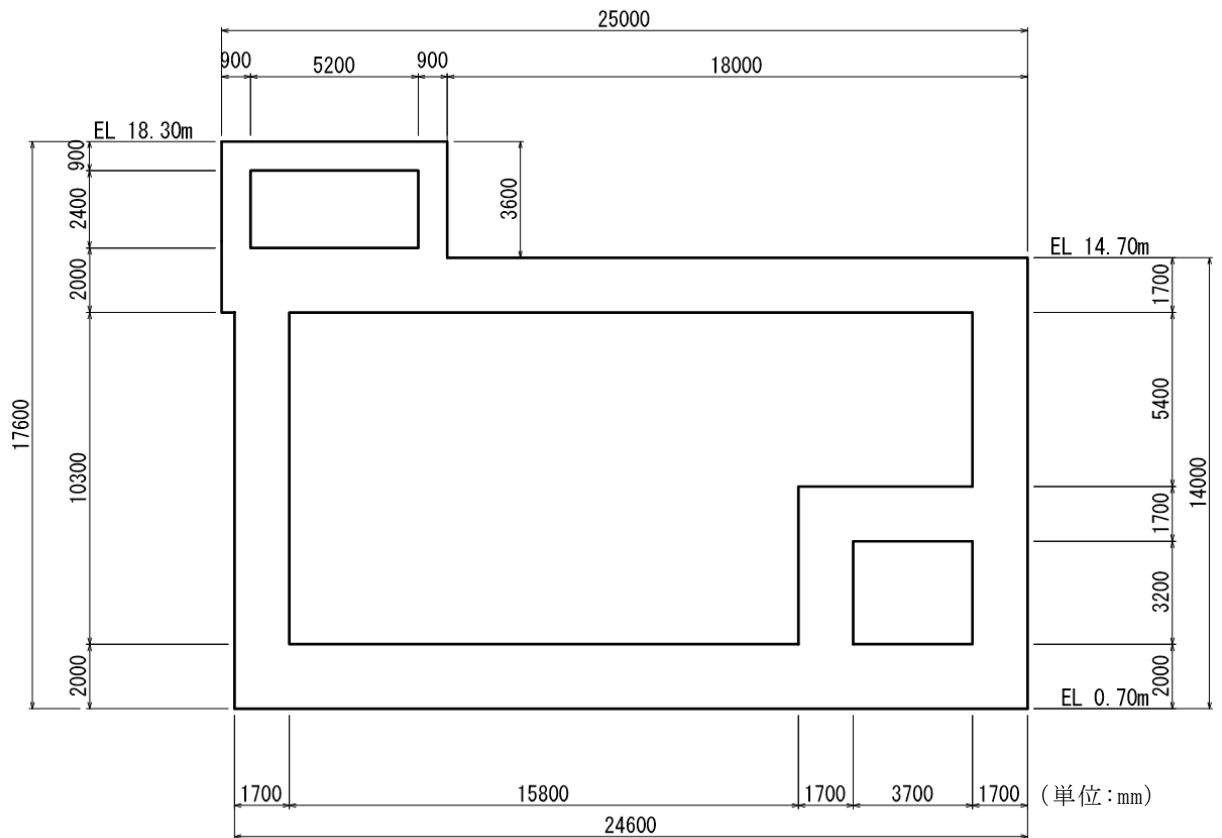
(3) 第 1 ベントフィルタ格納槽 断面図 (C-C 断面)
